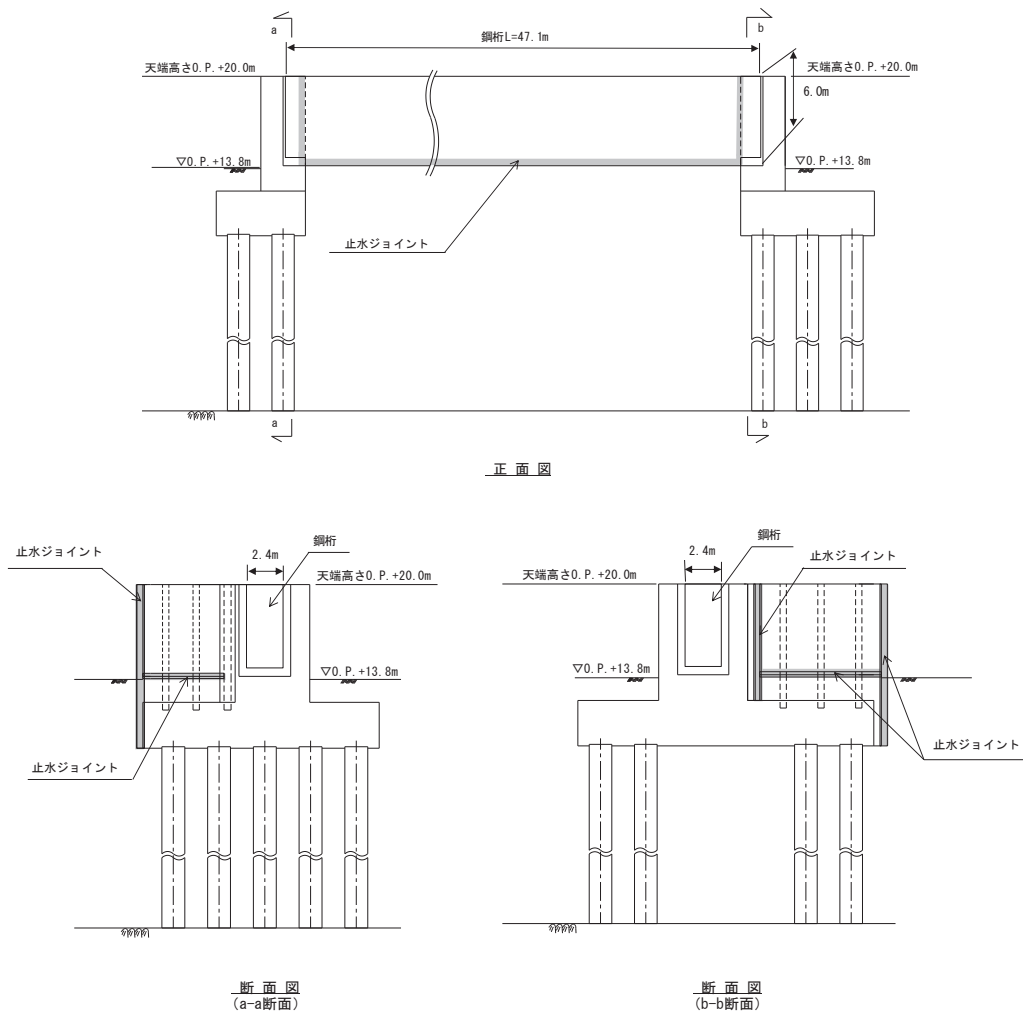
鋼製遮水壁（鋼桁 4） 正面図及び断面図
